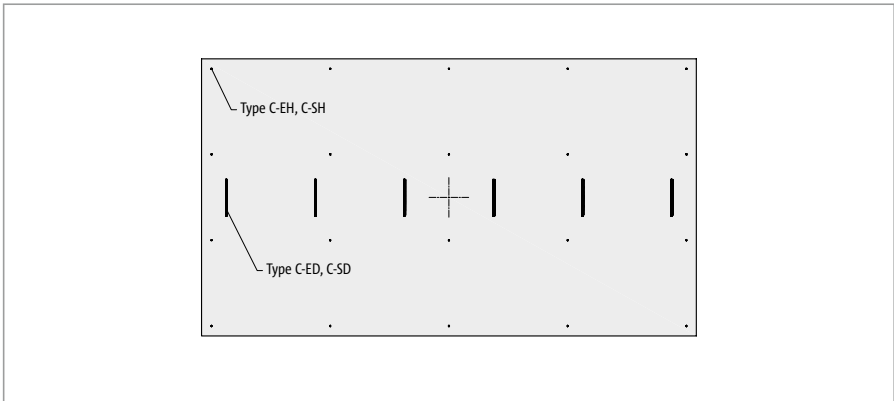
Schöck Isolink® : panneau extérieur suspendu ; le type C-ED, C-SD est disposé sur l'axe horizontal passant par le centre de gravité du panneau extérieur
